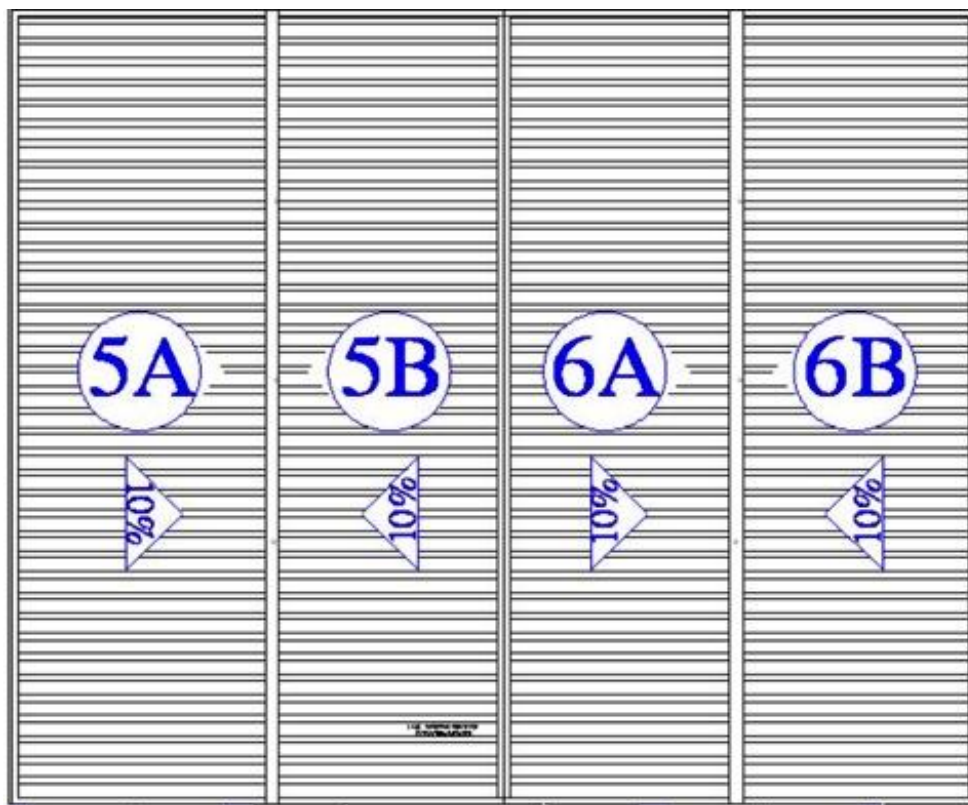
Área de contribuição, telhado do estacionamento, 4º pavimento.
